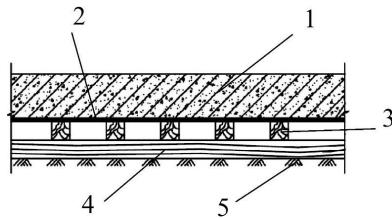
Узел А: 1 – монолитное железобетонное перекрытие; 2 – щиты опалубки; 3 – деревянные лежни; 4 – щебень; 5 – песчаная подготовка
